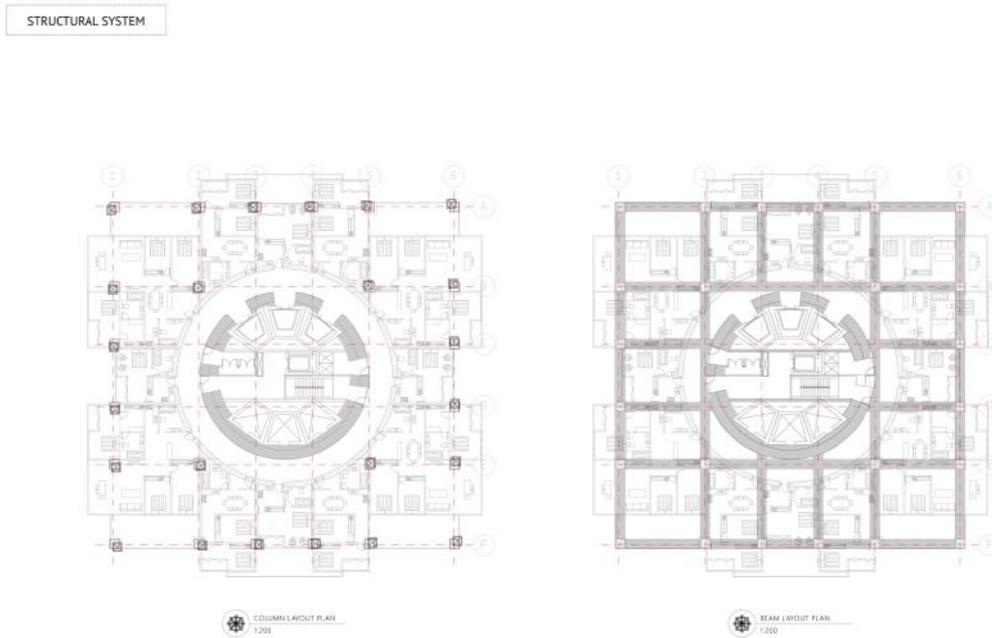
Layout Plan. Sumber: Dok.Prbadi
